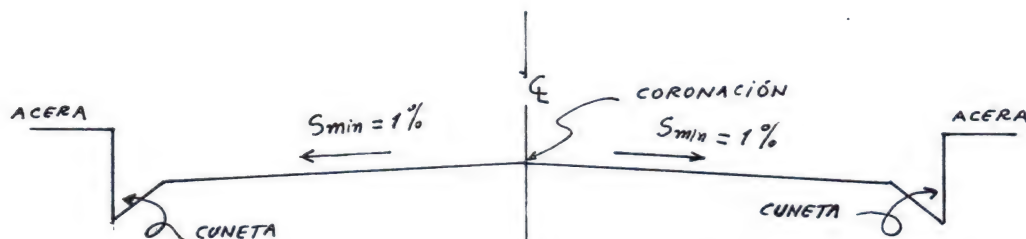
SECCIÓN RECOMENDABLE PARA CALLE CON ANCHO MAYOR QUE 8 M.
